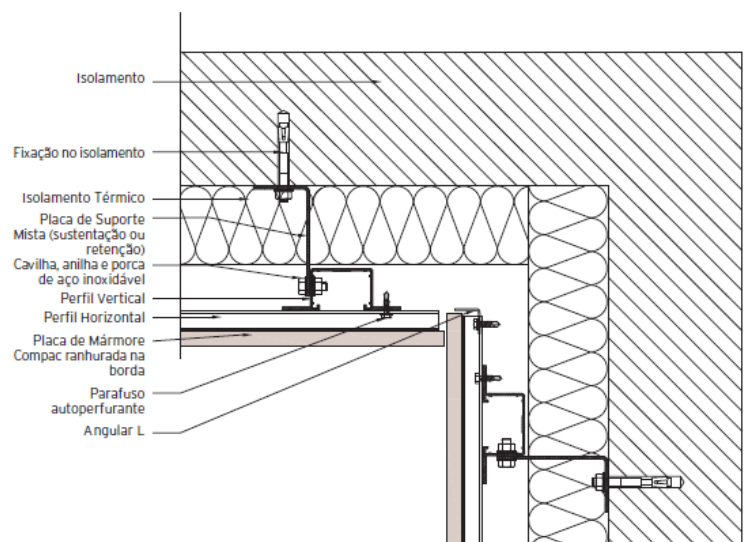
Detalhe construtivo de pormenor de ângulo [79].
